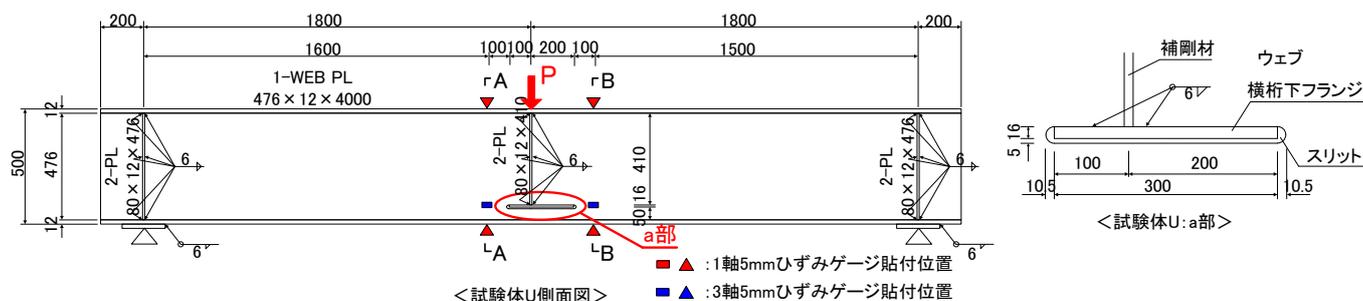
試験体の形状・寸法とひずみゲージ貼付位置
